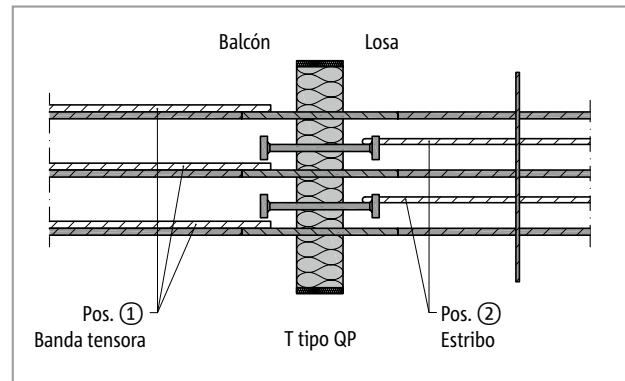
Schöck Isokorb® T tipo Q-P: Detalle 1; conexión de la armadura, banda tensora
